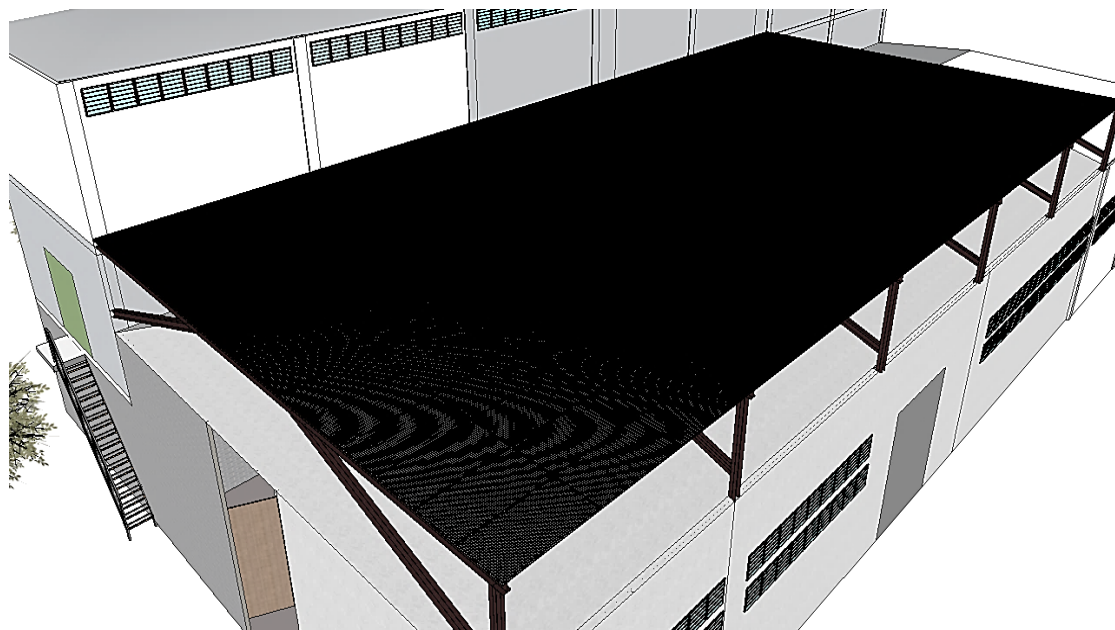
Vista de las rejillas o grating instaladas sobre la estructura metálica.
